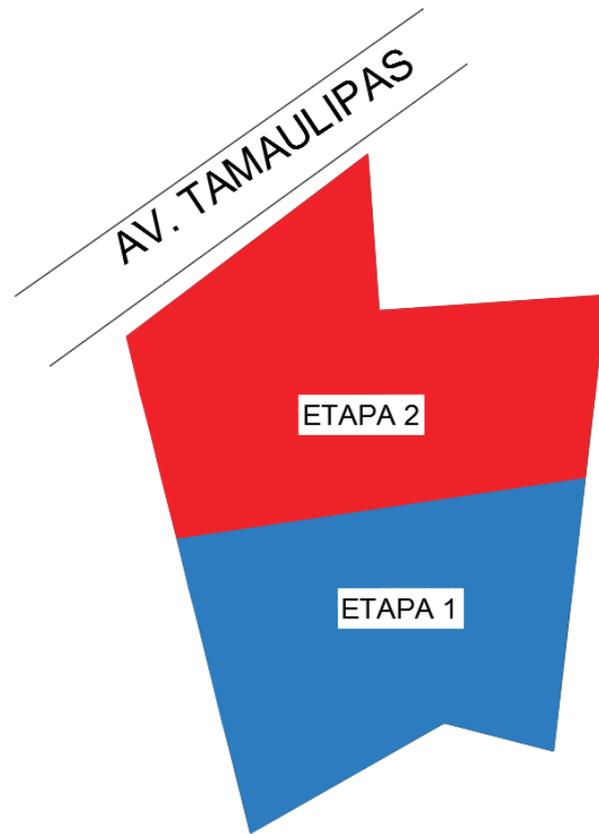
ETAPAS DE EXCAVACIÓN
